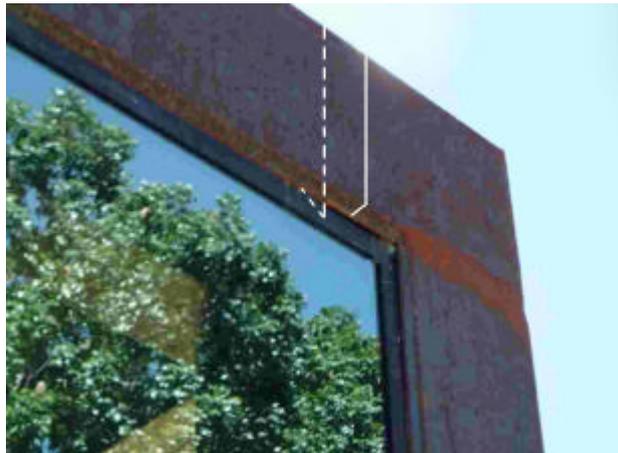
Detalhe acabamento: linha tracejada perfil projetado; linha cheia perfil executado.
